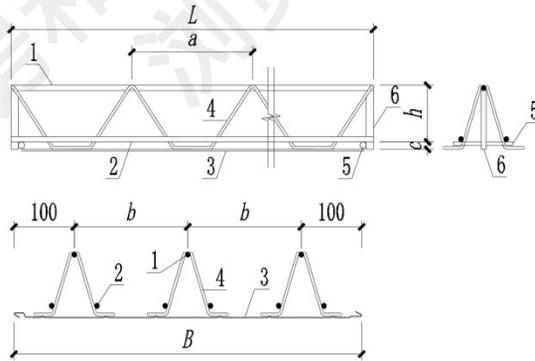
钢底模钢筋桁架楼承板立面、剖面图
